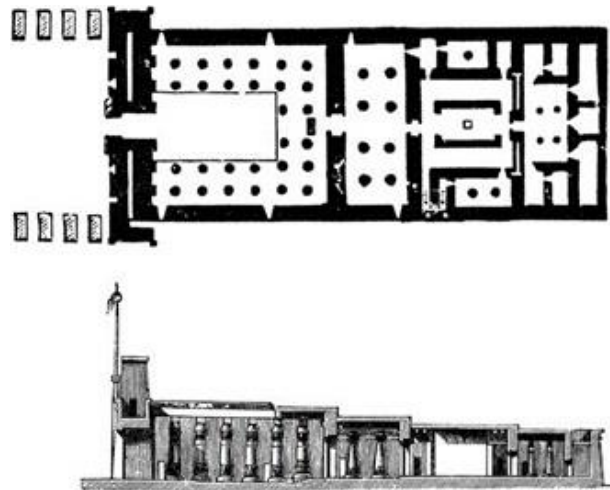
Templo de Jonsu, Planta y Sección. Fuente:(García, 2014)
